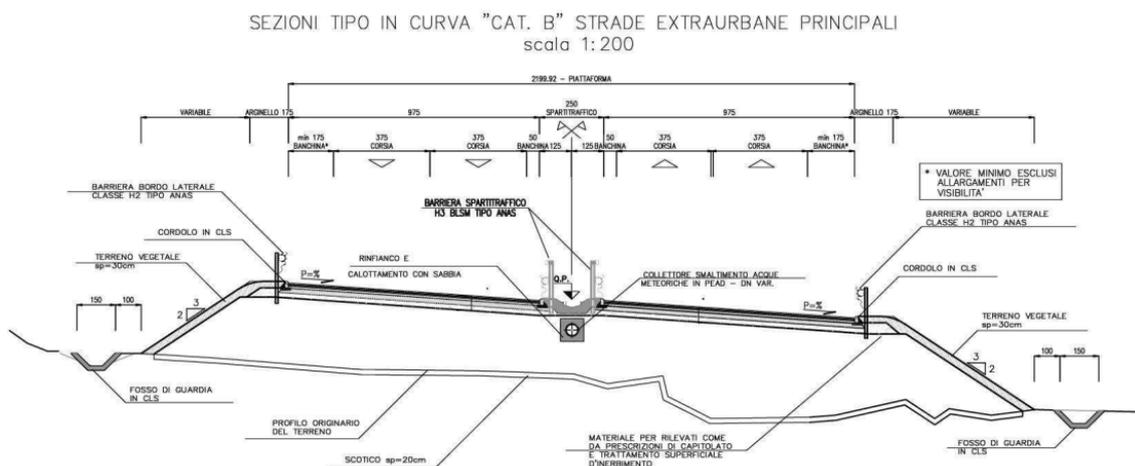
Asse principale, sezione tipo nel tratto di progetto
